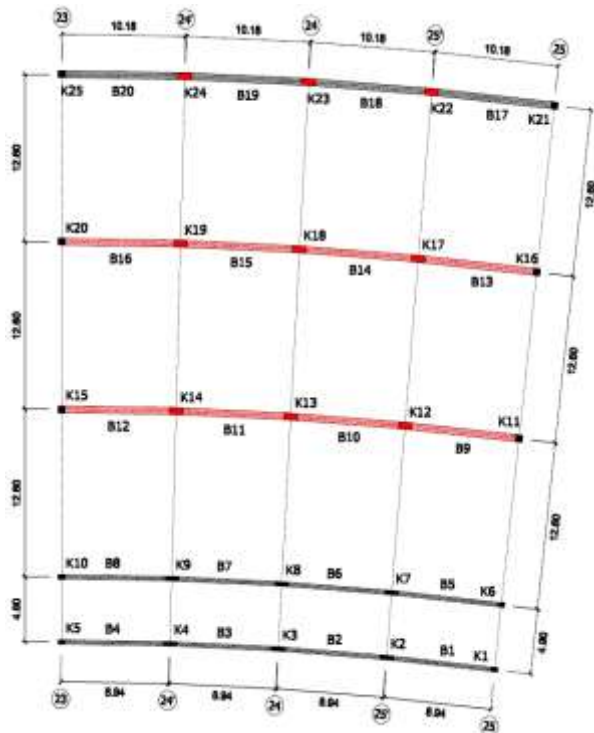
Lokasi Balok & Kolom Terminal 1A Lantai 1 Sebelah Kiri
